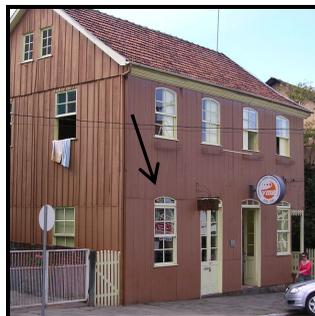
Recuperação da fachada original. Fonte: Autora, 2008
